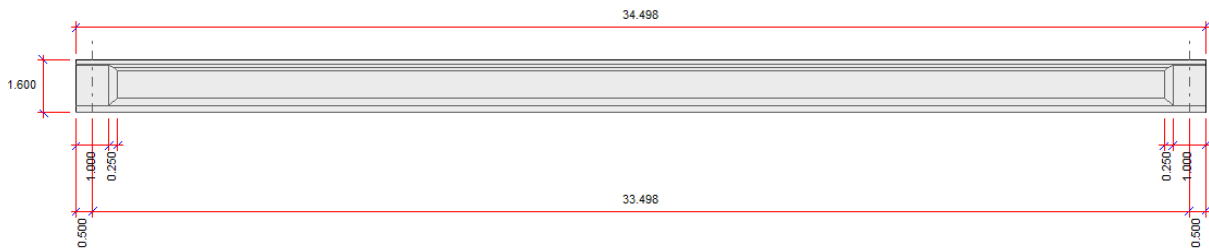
Alzado de viga. Fuente: IDOM-DEHC.
